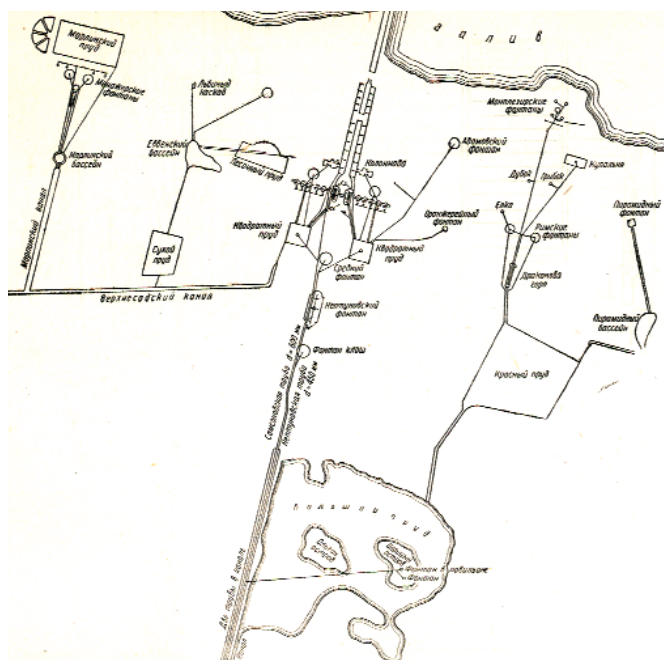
План расположения Петергофских фонтанов, водопроводных труб и каналов (1859 г.)
